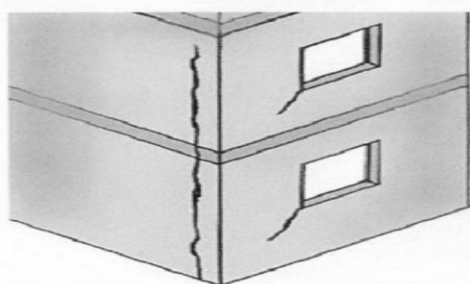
Fissura vertical causada pela expansão dos tijolos cerâmicos.
